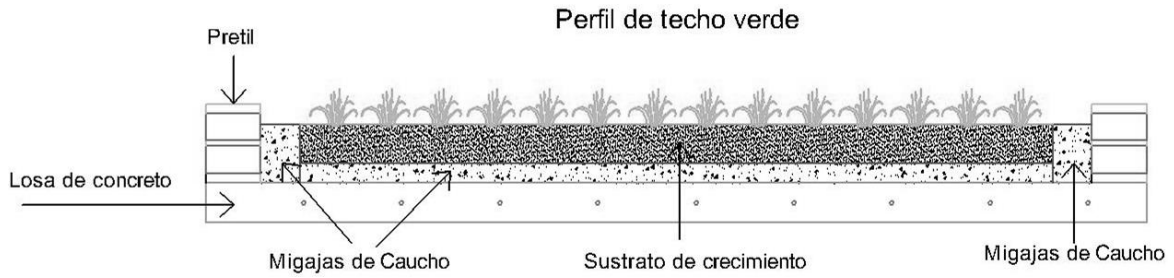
Detalles en perfil de techo verde habilitado en el módulo
